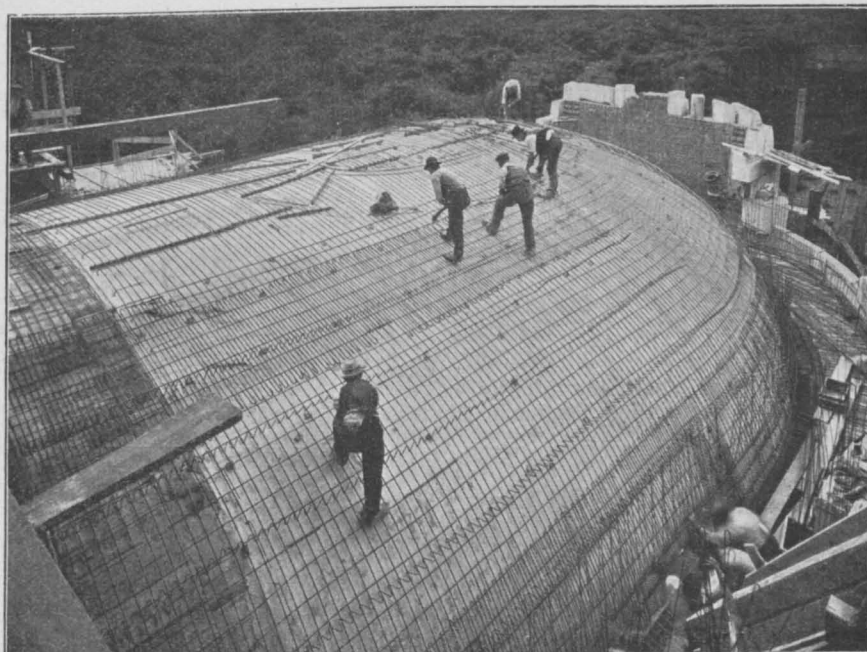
Aufsicht auf die eingeschaltete Kuppel mit den verlegten Eisen.
